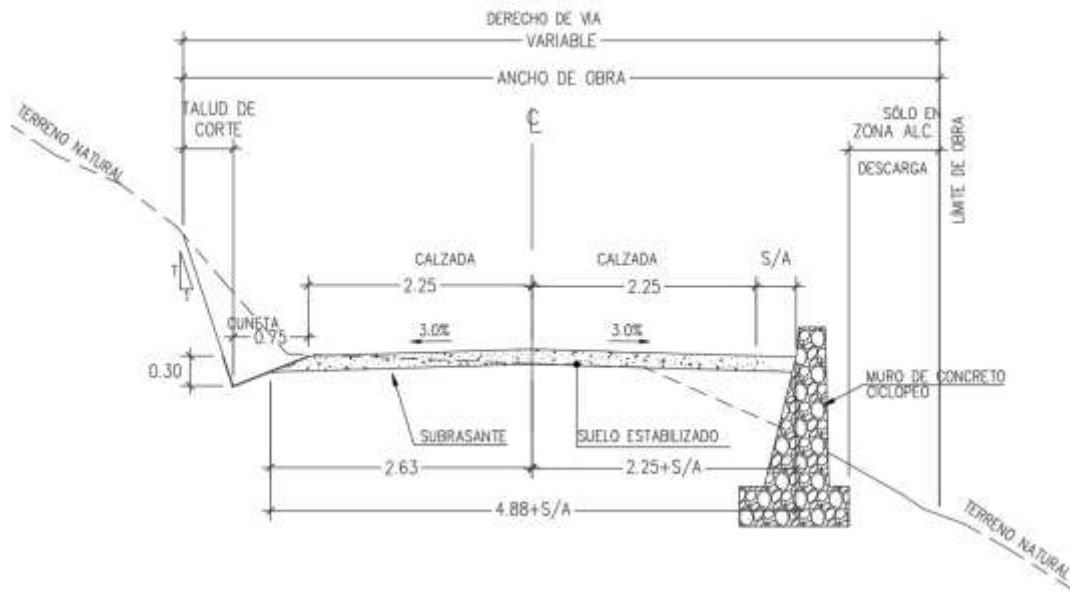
Sección típica a media ladera con muro de contención. Fuente:Plano de secciones típicas
